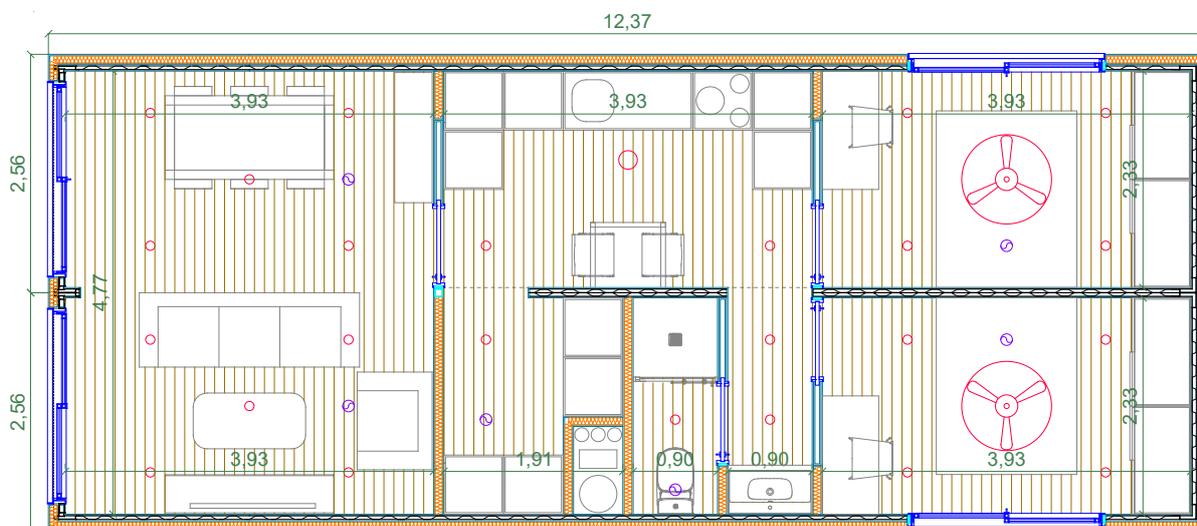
Distribución en planta de vivienda 3D a partir de 3 contenedores de 40 pies.
